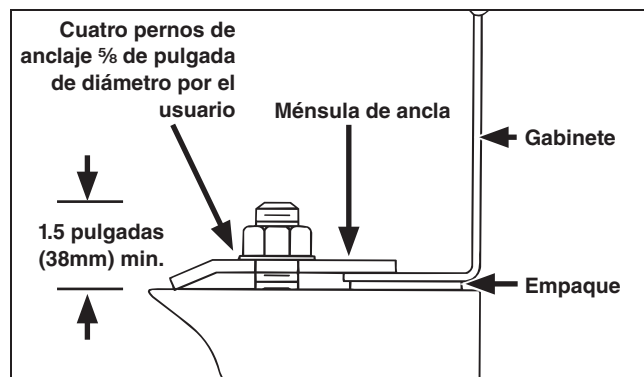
Un repuesto adecuado del anclaje-ménsula.
